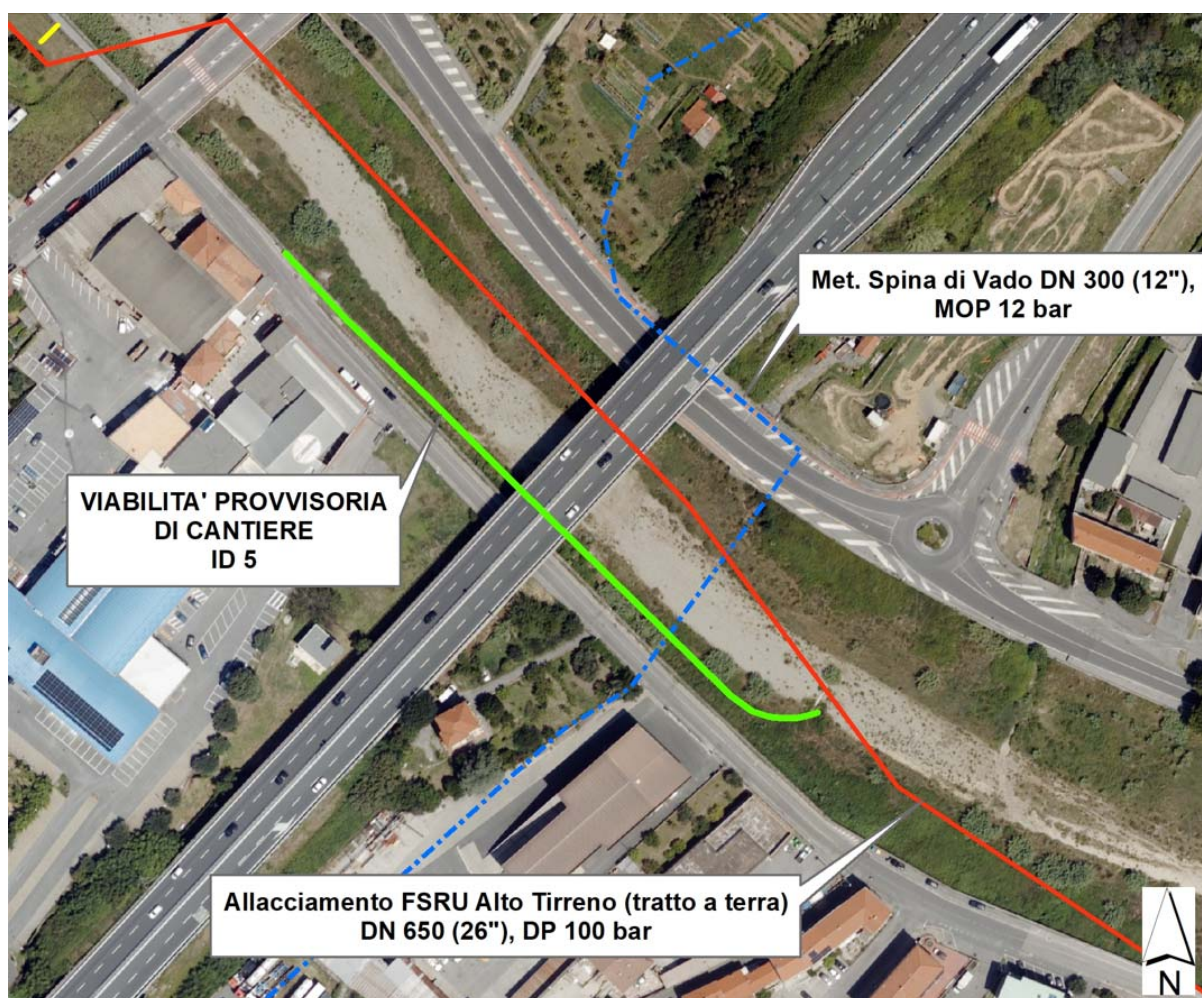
Planimetria di inquadramento della strada provvisoria di cantiere ID5
